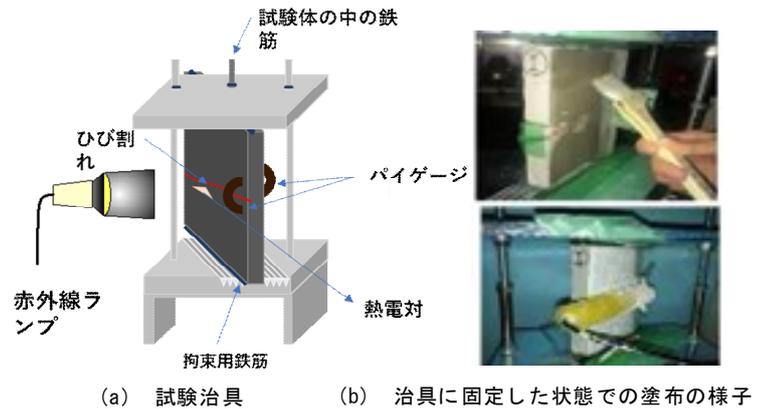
ひび割れ挙動のための試験治具と塗布試験体の作製の様子
